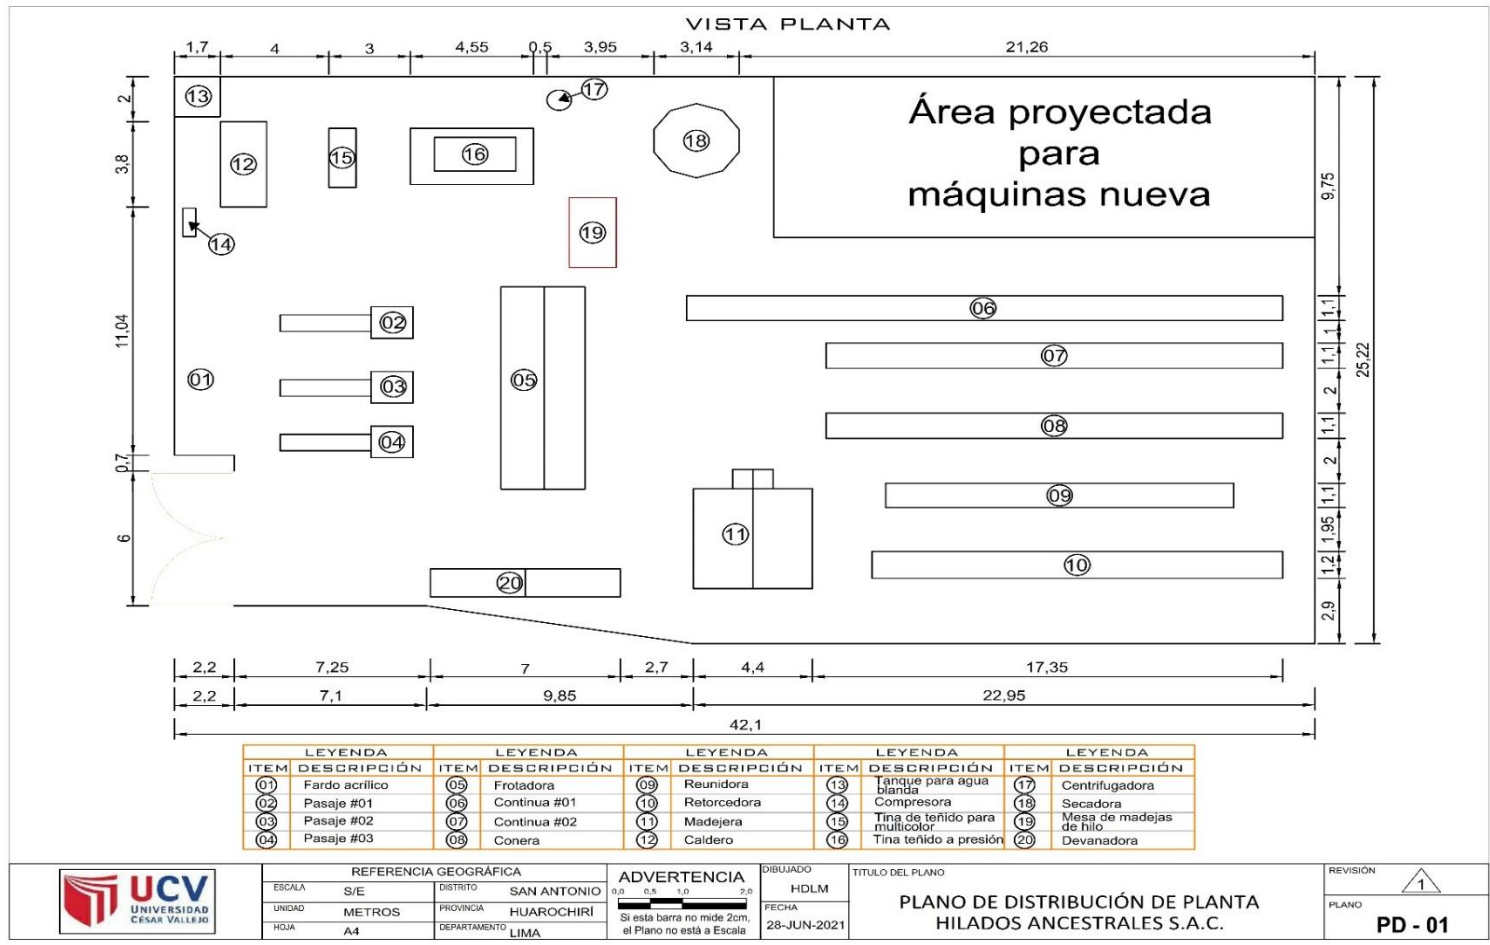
Plano de Distribución de Planta Hilados Ancestrales S.A.C.
